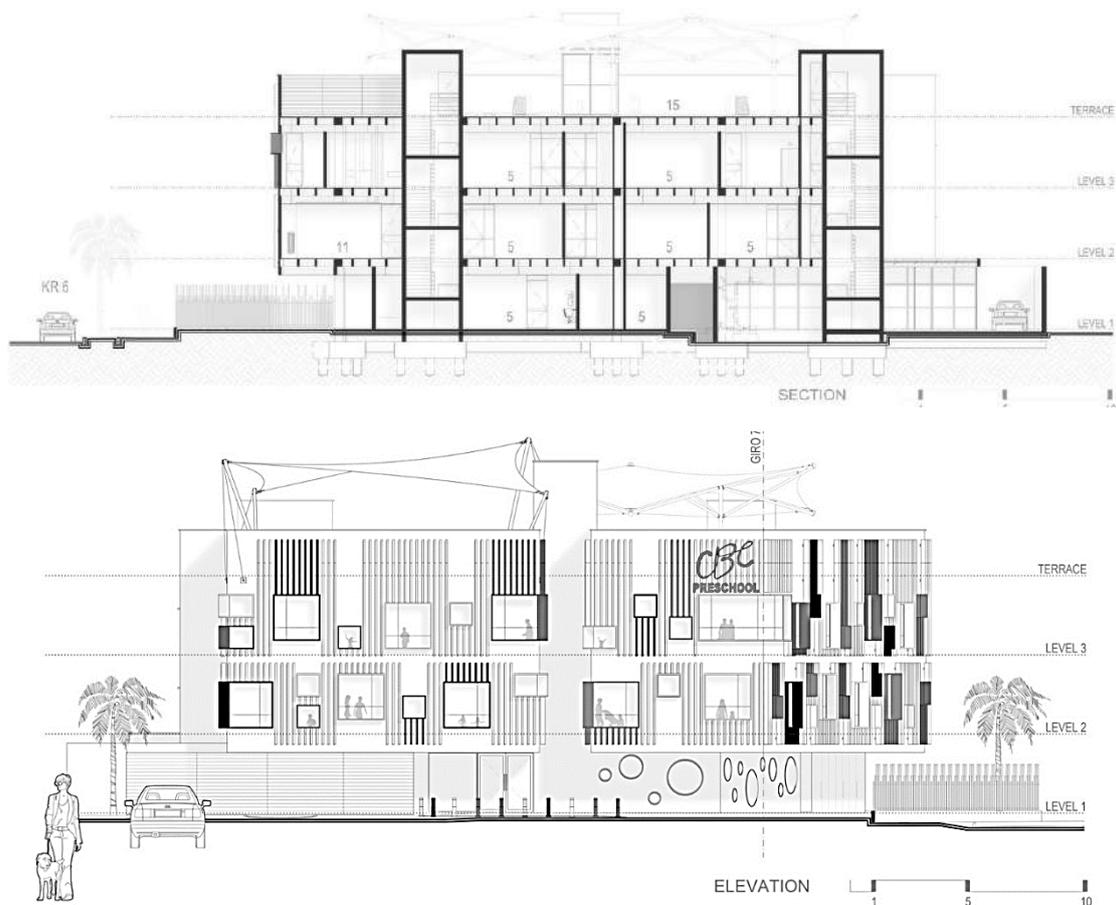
Plano de corte longitudinal y fachada, Preescolar Colegio Británico de Cartagena. Fuente: Página Web Archdaily.
